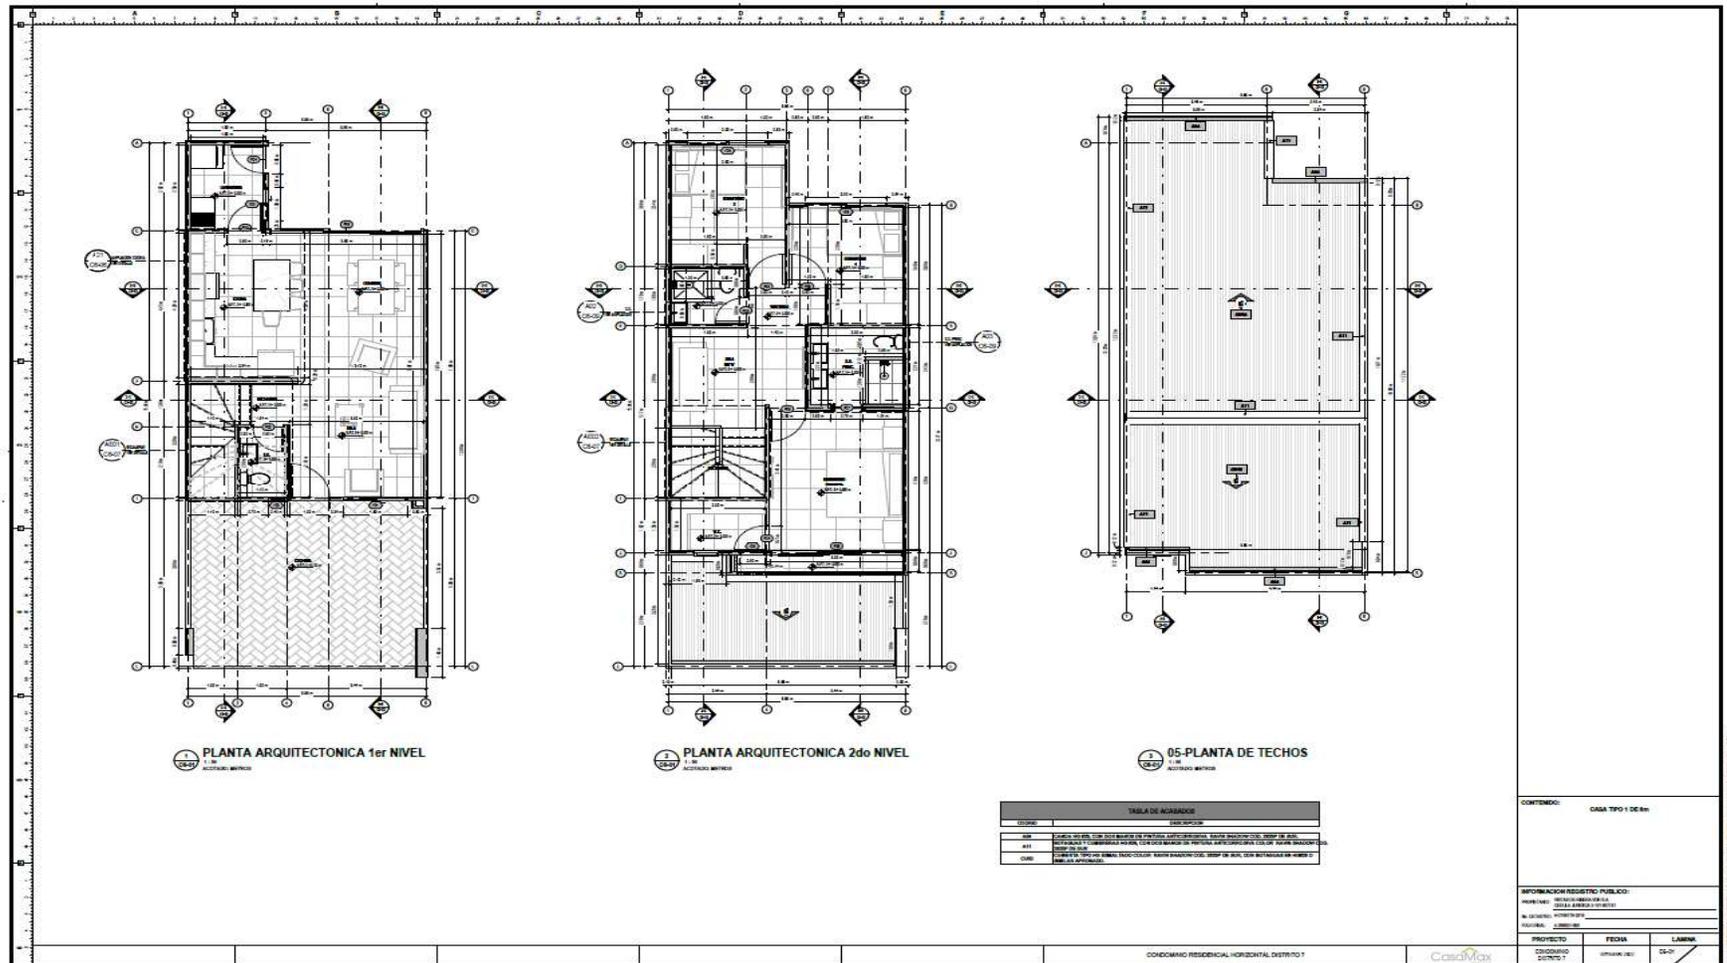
Planta Arquitectónica, Casa Modelo Tipo # 1. Lámina # C6-01
